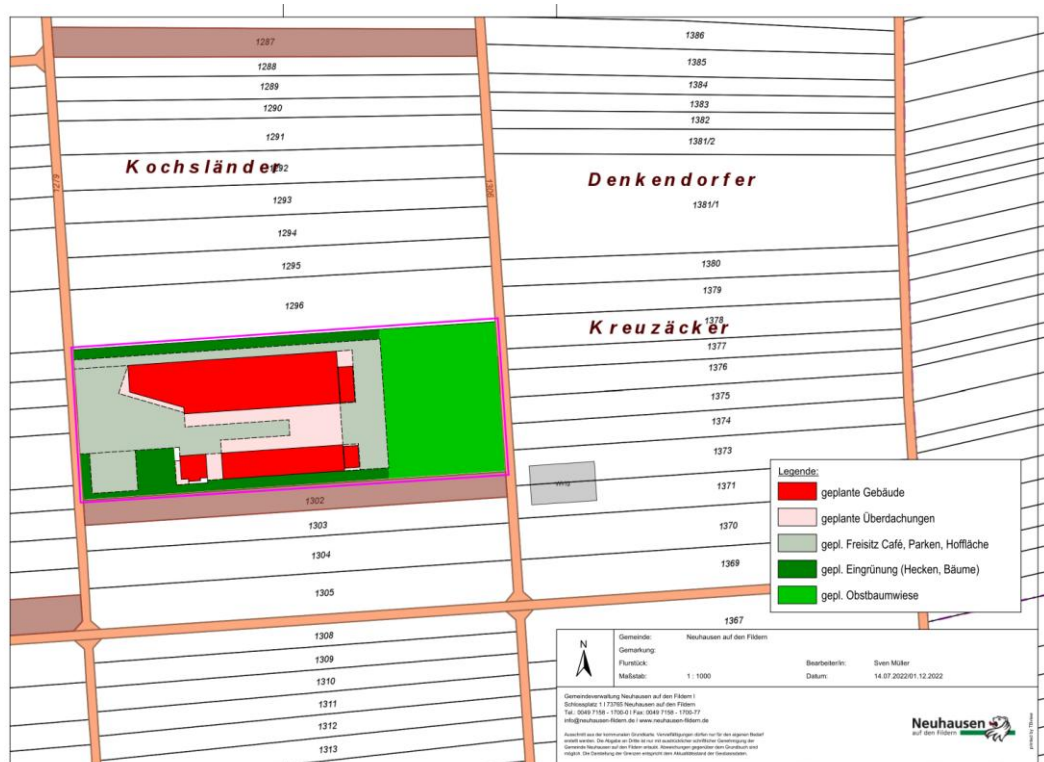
Lageplan Vorhabenplanung, Merk-Mühlberger Architekten, 13.08.2015.
